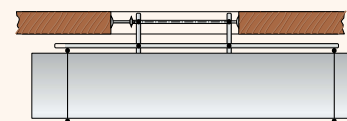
Amarrage sur tubes complémentaires (cette solution permet de dégager le passage sur les plates-formes de travail)
